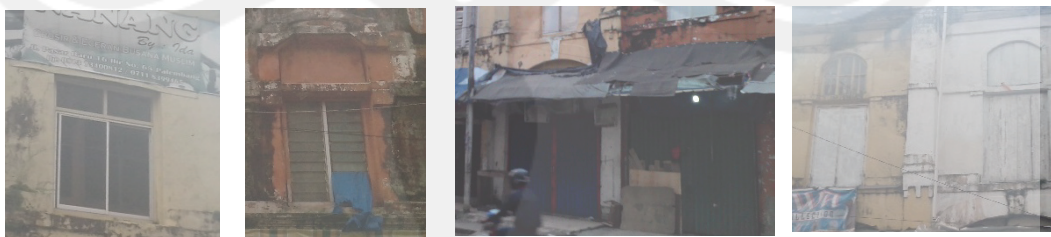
Tipe Ornamen dan bentuk kolom pada ruko 16 Ilir
